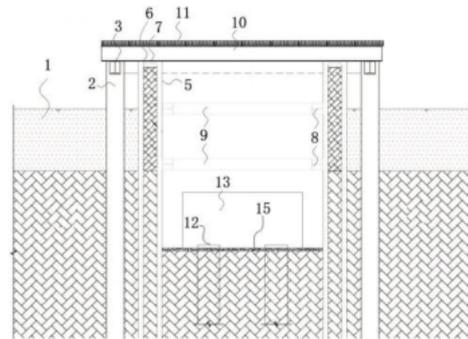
河道泄洪区域水下桩承台的施工方法中承台围堰单元的纵剖面图
